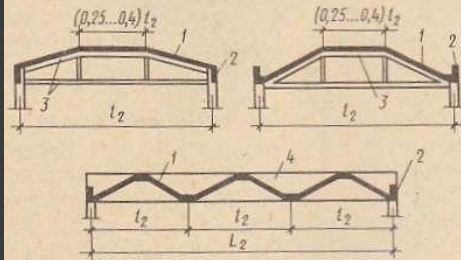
Типы поперечных сечений железобетонных складчатых покрытий:
